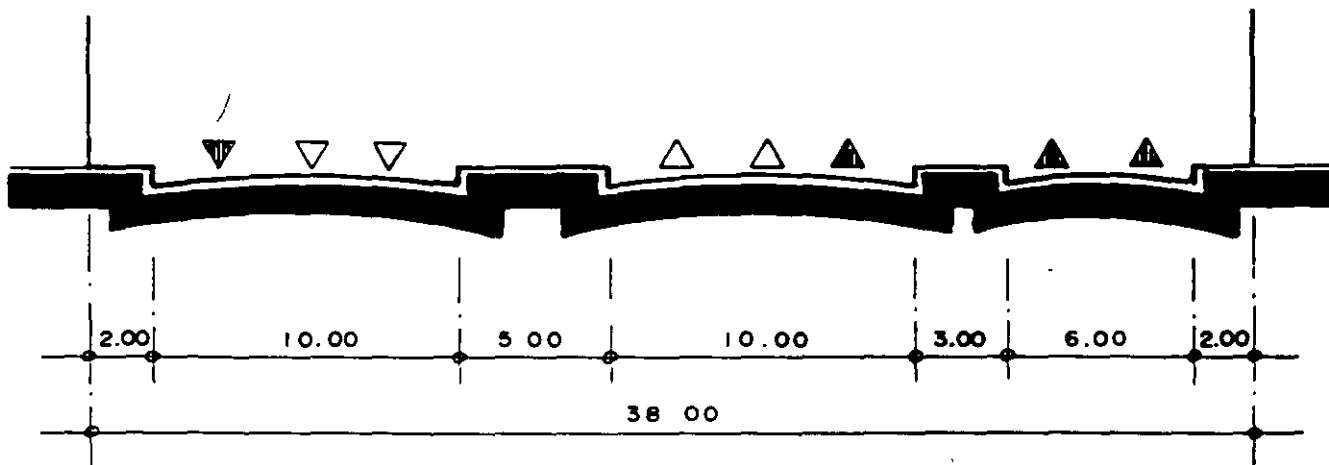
AUTOPISTA SUR (CALLE LATERAL SUR)
